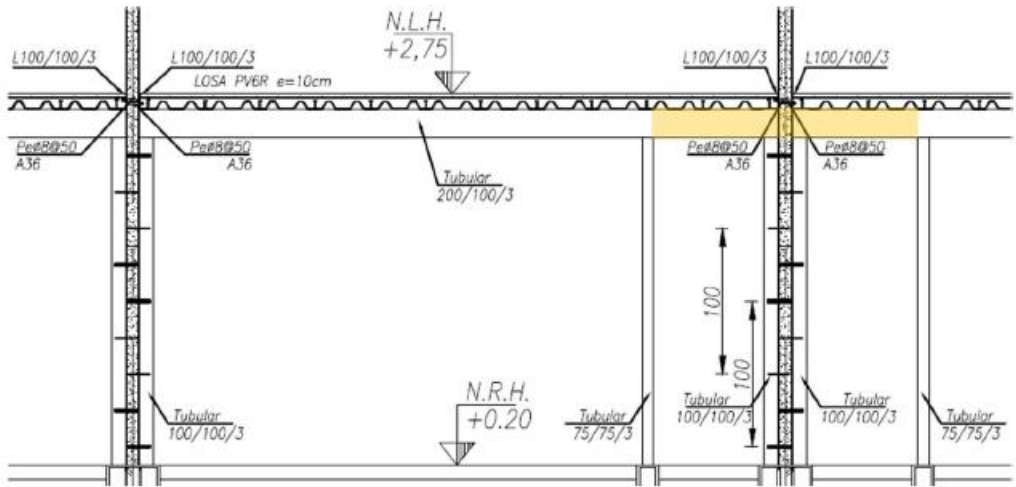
“Corte que muestra relación entre los paneles Fastwork y las columnas de acero [] 100x100x3 mm”.
